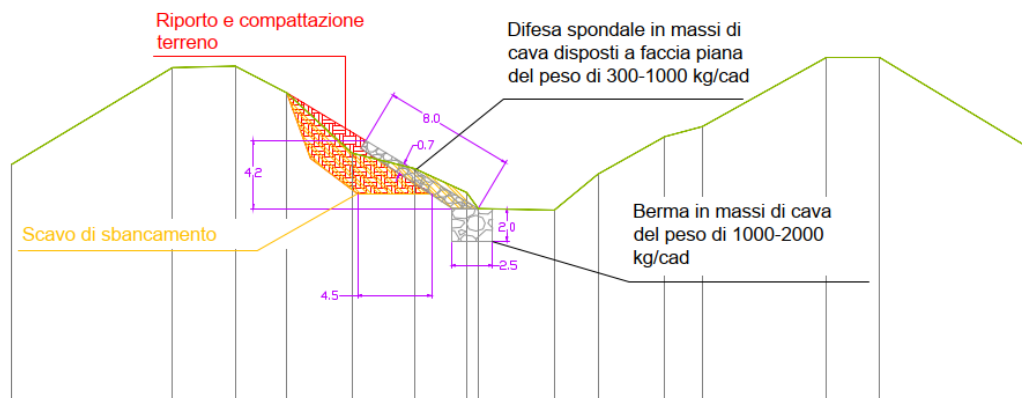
Sezione tipologica della ripresa spondale berma al piede in massi ciclopici, rivestimento in pietrame e risezionamento della sponda
